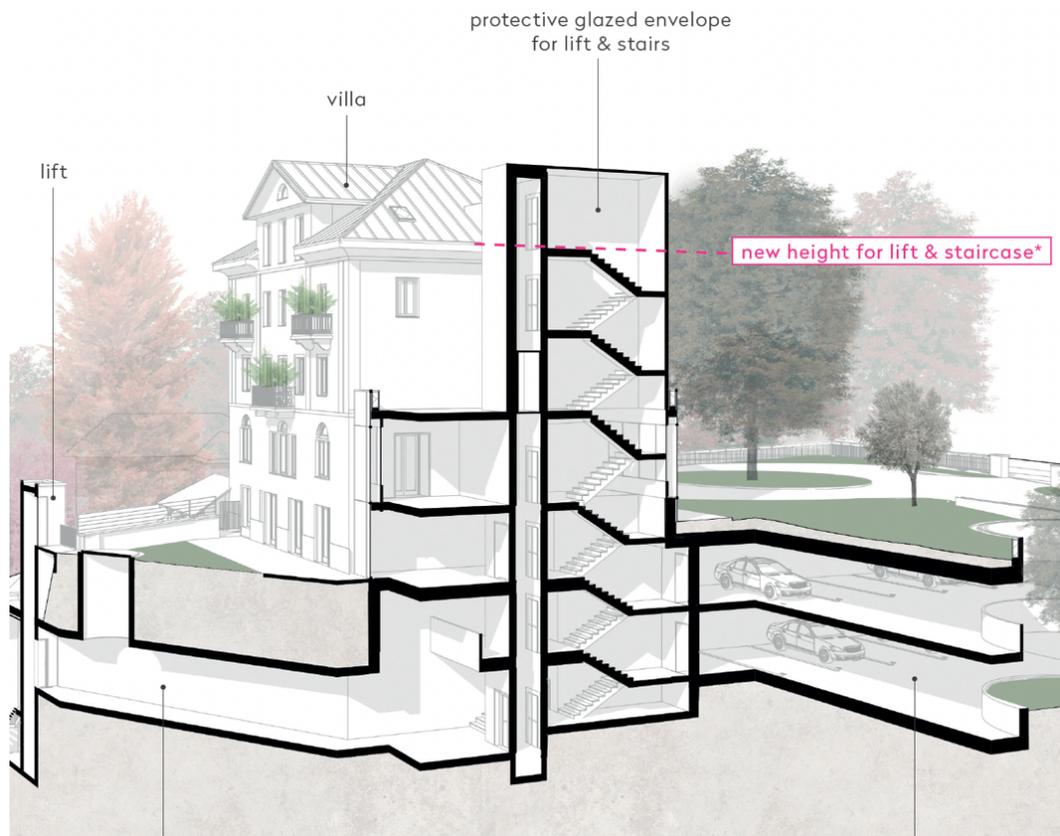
Liftschacht nordöstlich der Treppenanlage geplant
